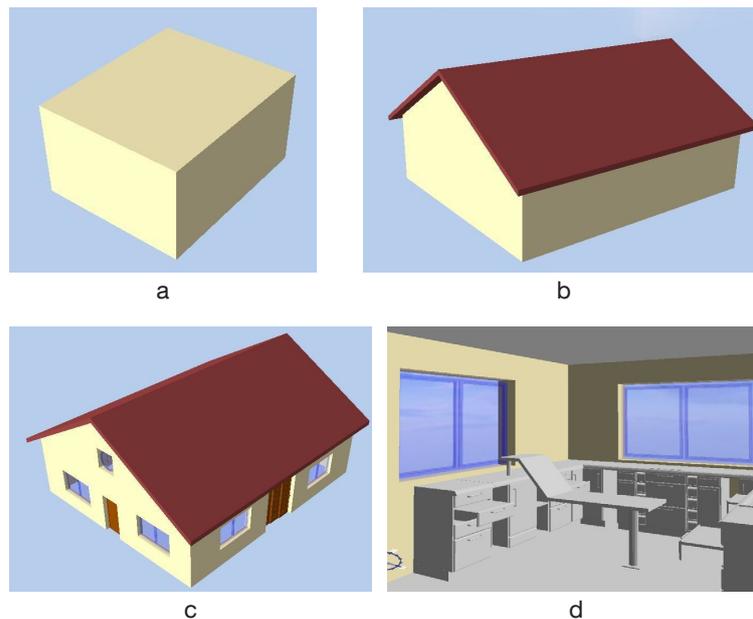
Level of Detail (LoD) nach dem CityGML Standard. a) LoD1: Klötzchenmodell; b) LoD2: Dachformen; c) LoD3: Dachformen und Fassadenelemente; d) LoD4: Architektur Modell
